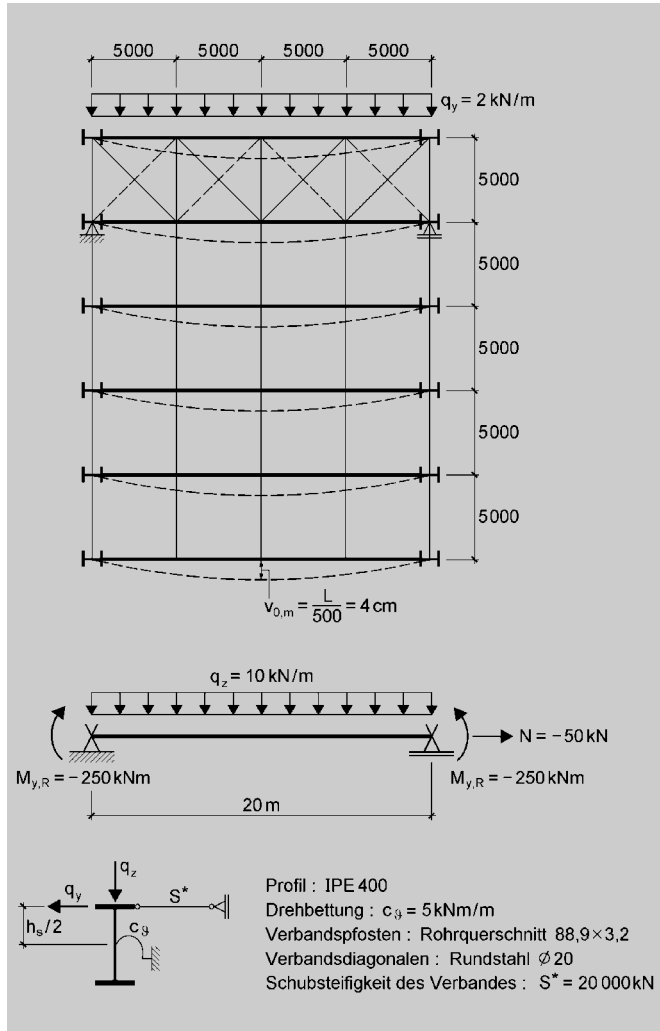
Statisches System, planmäßige Lasten und geometrische Ersatzimperfectionen
